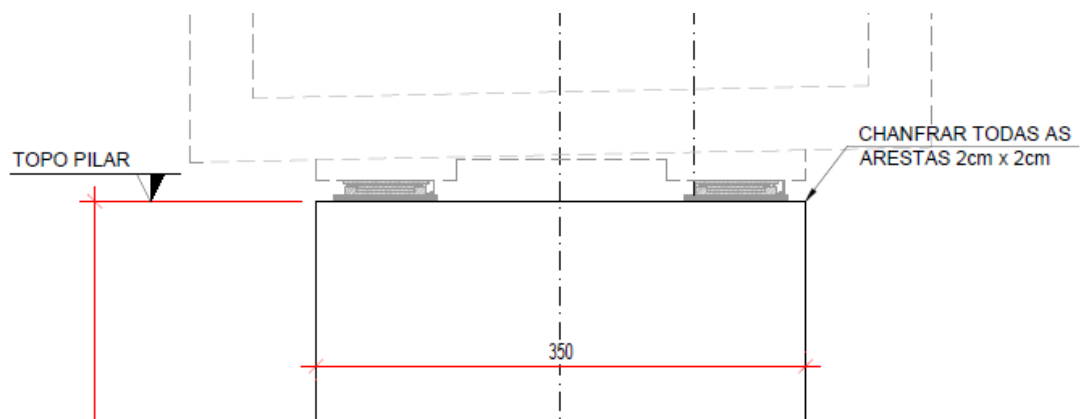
DETALHE DO TOPO DOS PILARES
